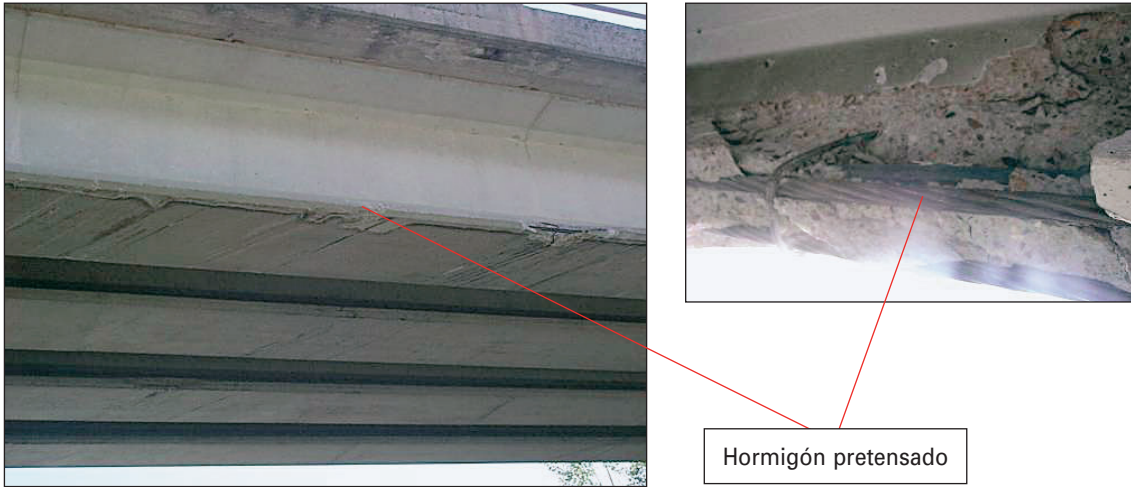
MATERIAL: HORMIGÓN PRETENSADO.
